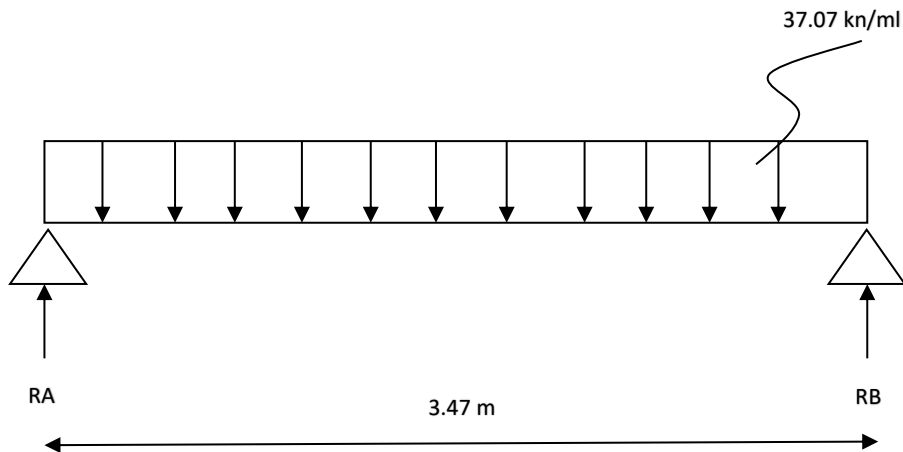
schéma statique de la poutre palière a l'ELS
